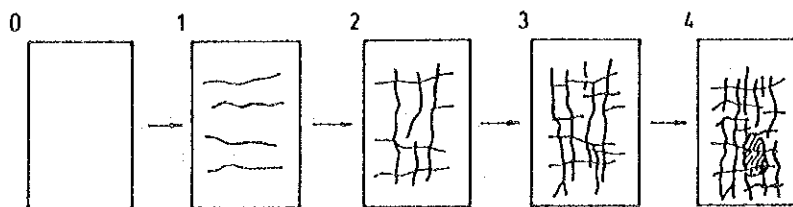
Detalle del Fisuramiento de la Losa
